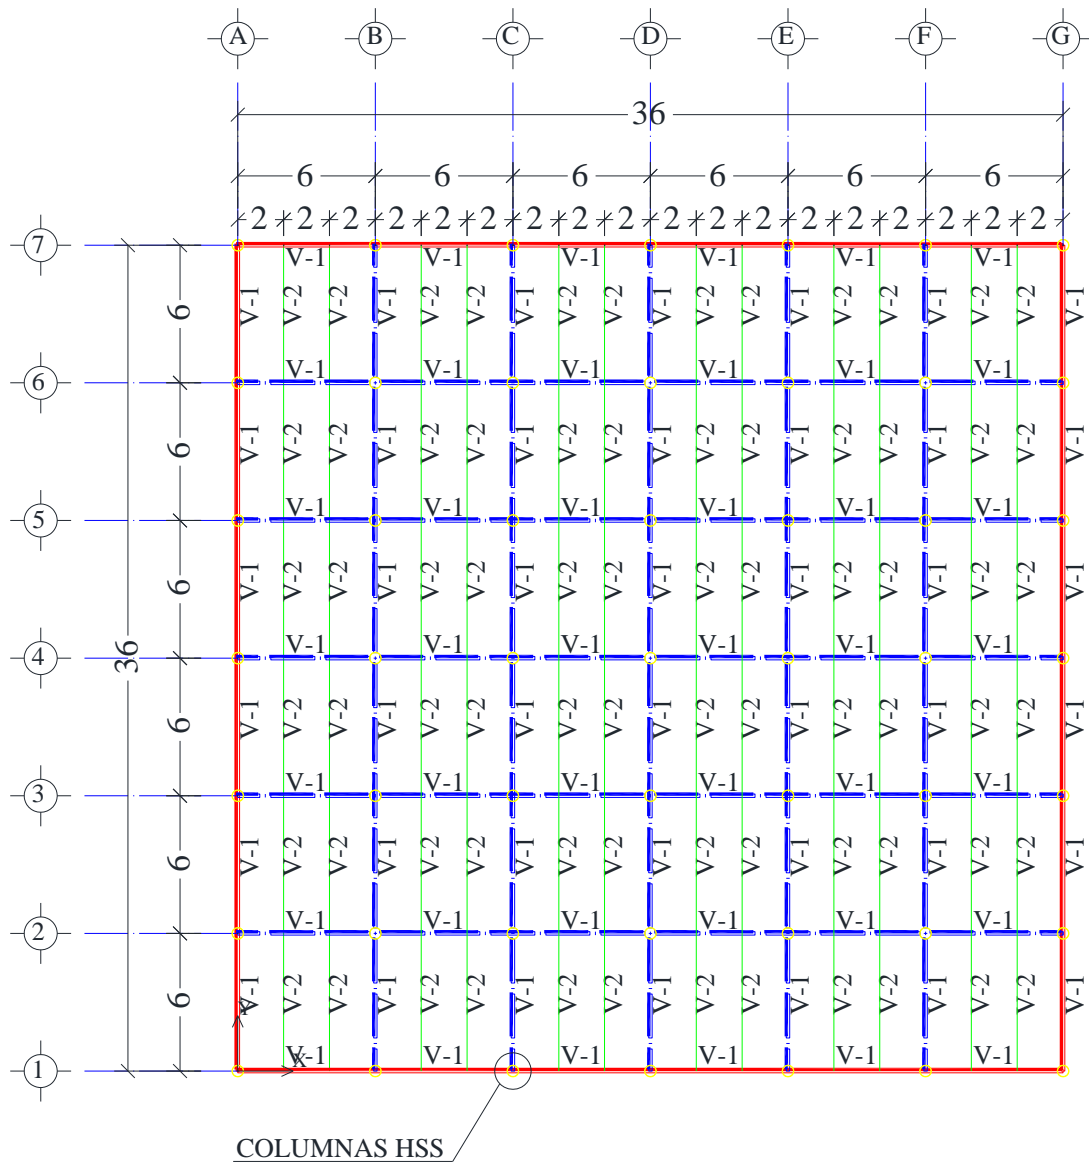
Planta de azotea de vigas y columnas para los edificios de 3, 5 y 7 niveles.
